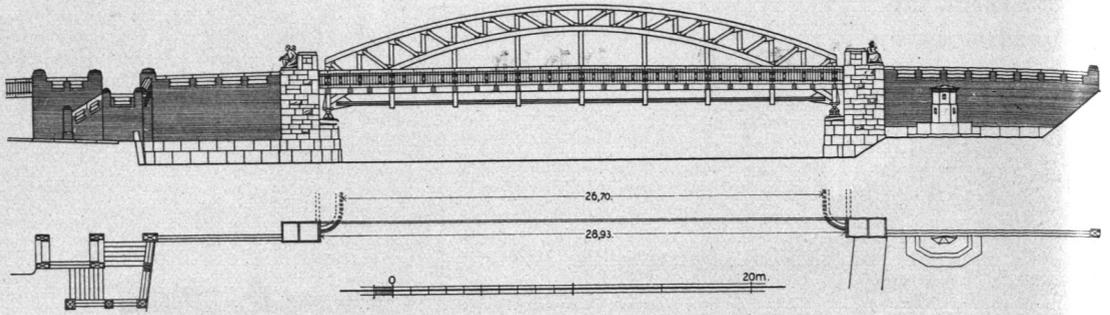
und 316. Brücke Auschlägerweg, Ansicht und Brüstungsgrundriß.
